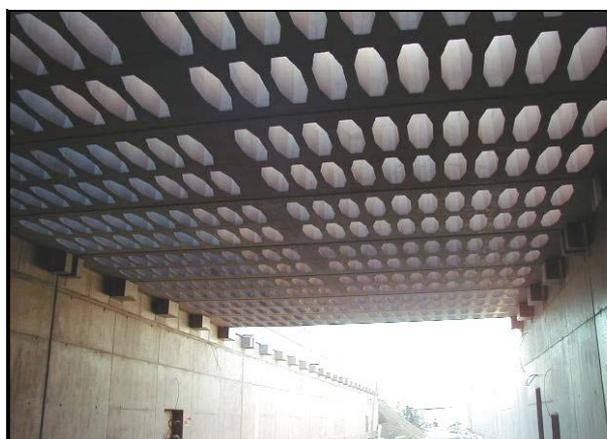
Rasterdecke Kappler Tunnel aus Fertigteilen mit Portlandschieferzement „Terrament“
